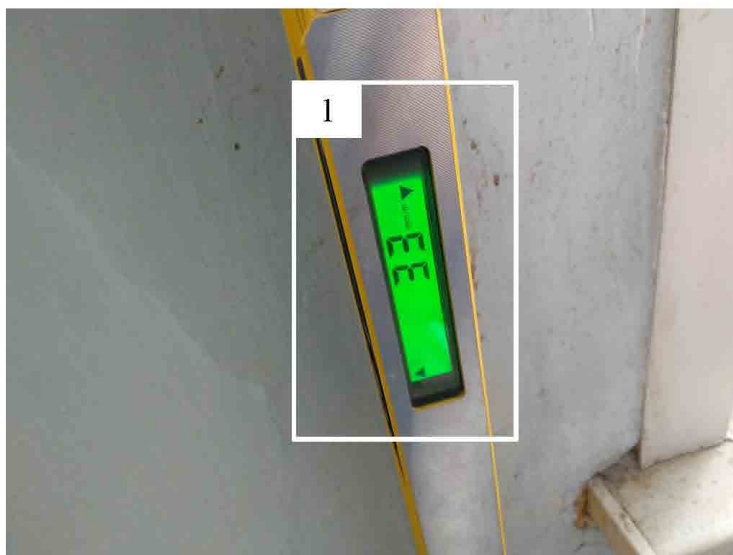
Наружная стена. Дефекты: 1 – отклонение от вертикали.
